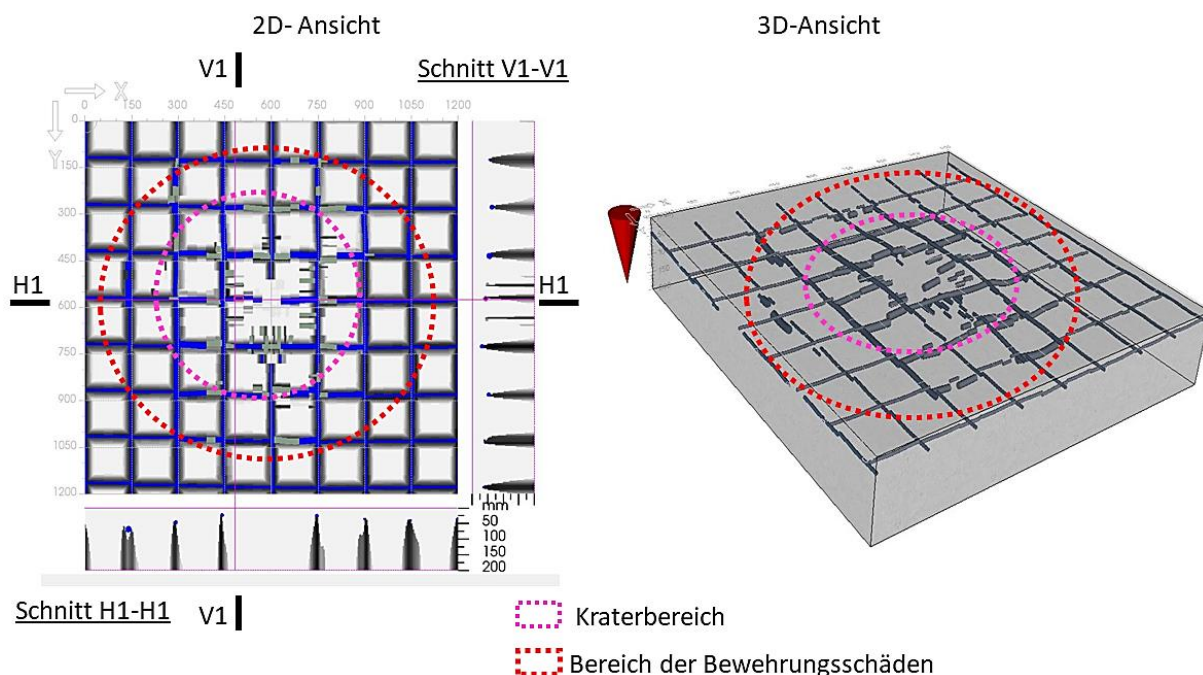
Darstellung des Kraterbereiches mit Bewehrungsschäden aus Ferrosan - Untersuchung der Stahlbetonplatte S-25-0-5 (Schutzseite).
